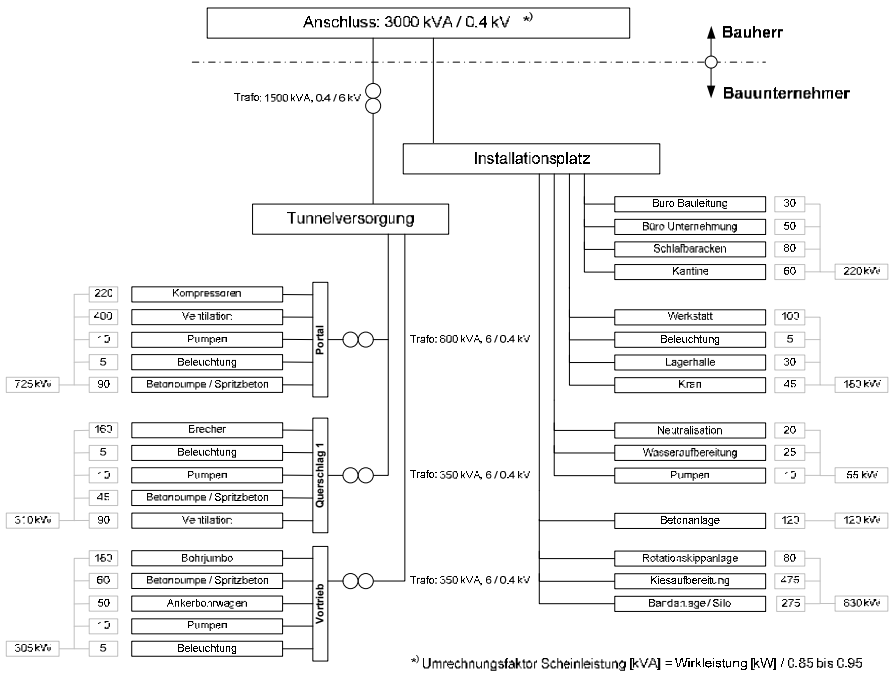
Elektroinstallationschema einer Baustelle (Tunnelbau, konventioneller Vortrieb) [2]
